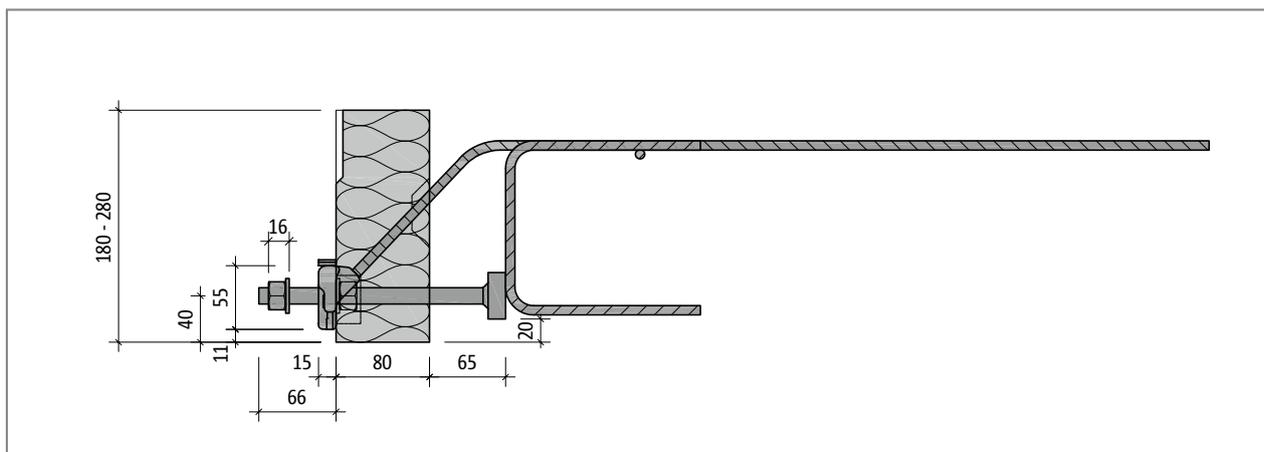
Schöck Isokorb® T type SQ-V1 : coupe du produit
